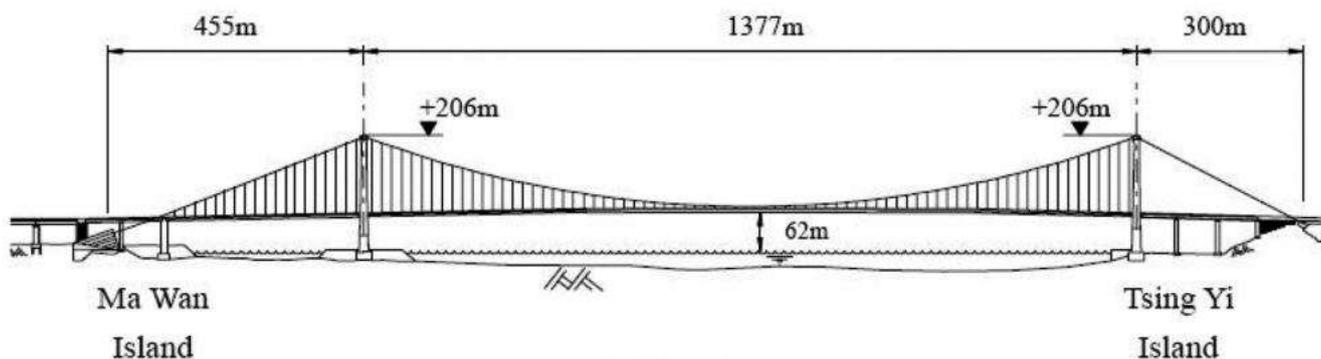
Sezione longitudinale dello Tsing Ma Bridge [22].
